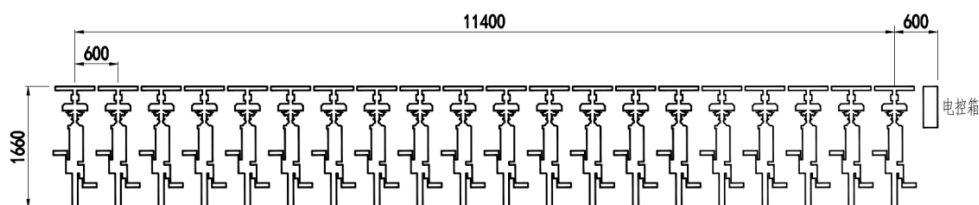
公共自行车停放点直排式示意图（以 20 辆为例，单位：mm）
